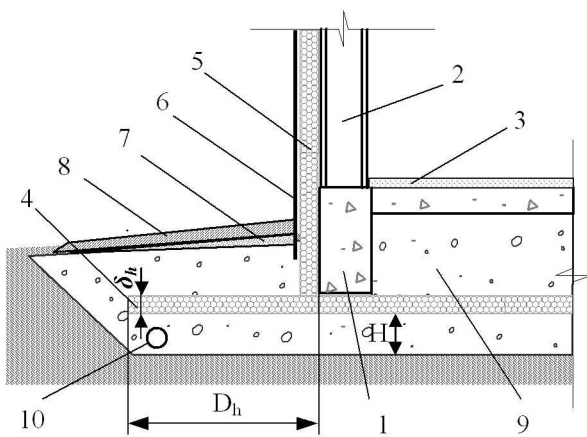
Схема укладки и параметры теплоизоляции «Пеноплэкс» в фундаментах зданий с переменным режимом эксплуатации (отапливаемое — неотапливаемое)
